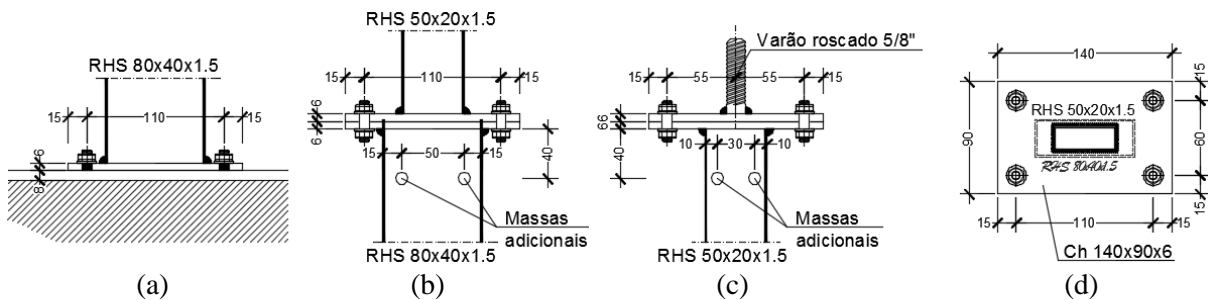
Pormenores fixação: a) perfil RHS 80x40x1.5 à chapa da base; b) ligação entre perfis; c) ligação de suporte antena GPS; d) chapa de entre perfis. (cotas em milímetros).
